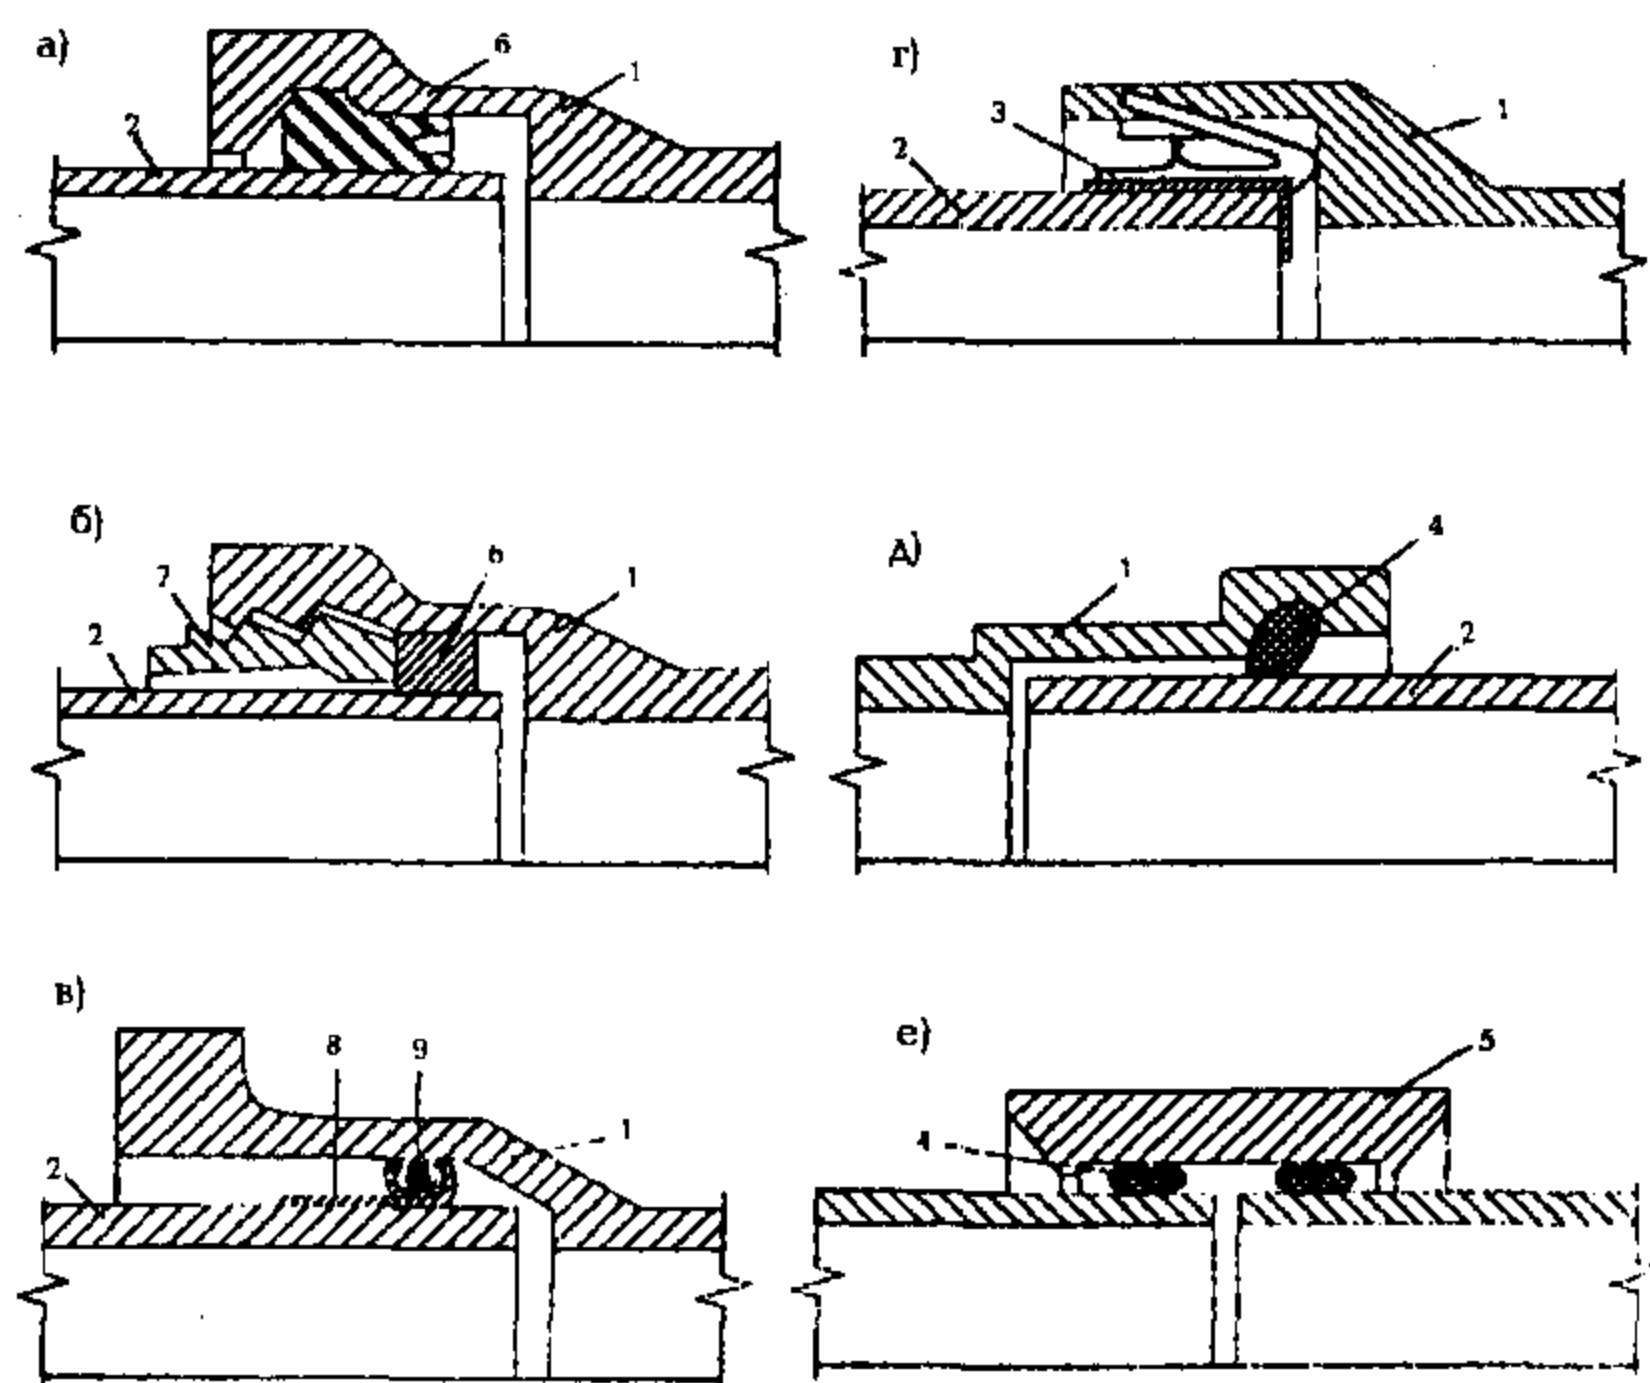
Стыковые соединения подземных трубопроводов:
